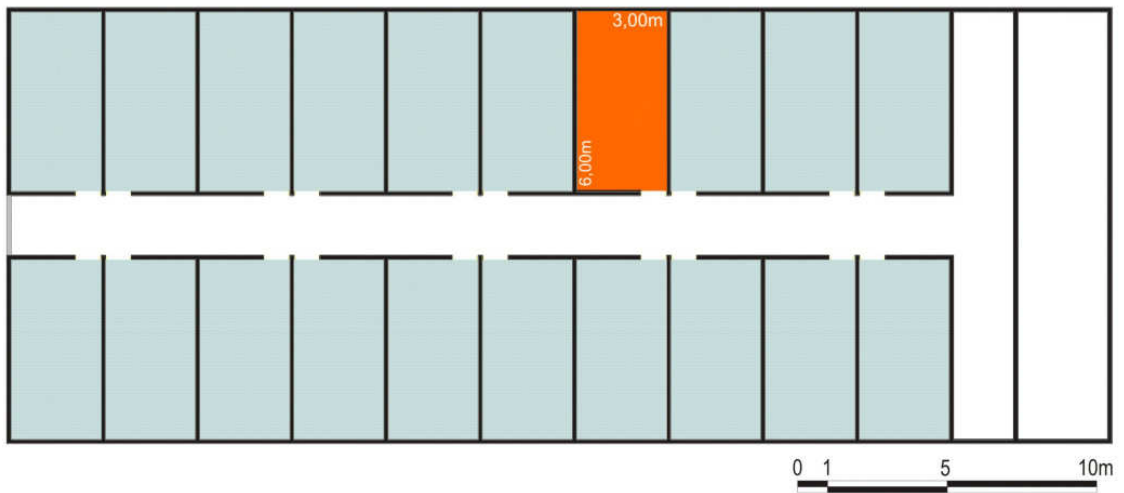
Planta baixa do caso base 2: corredor central.
